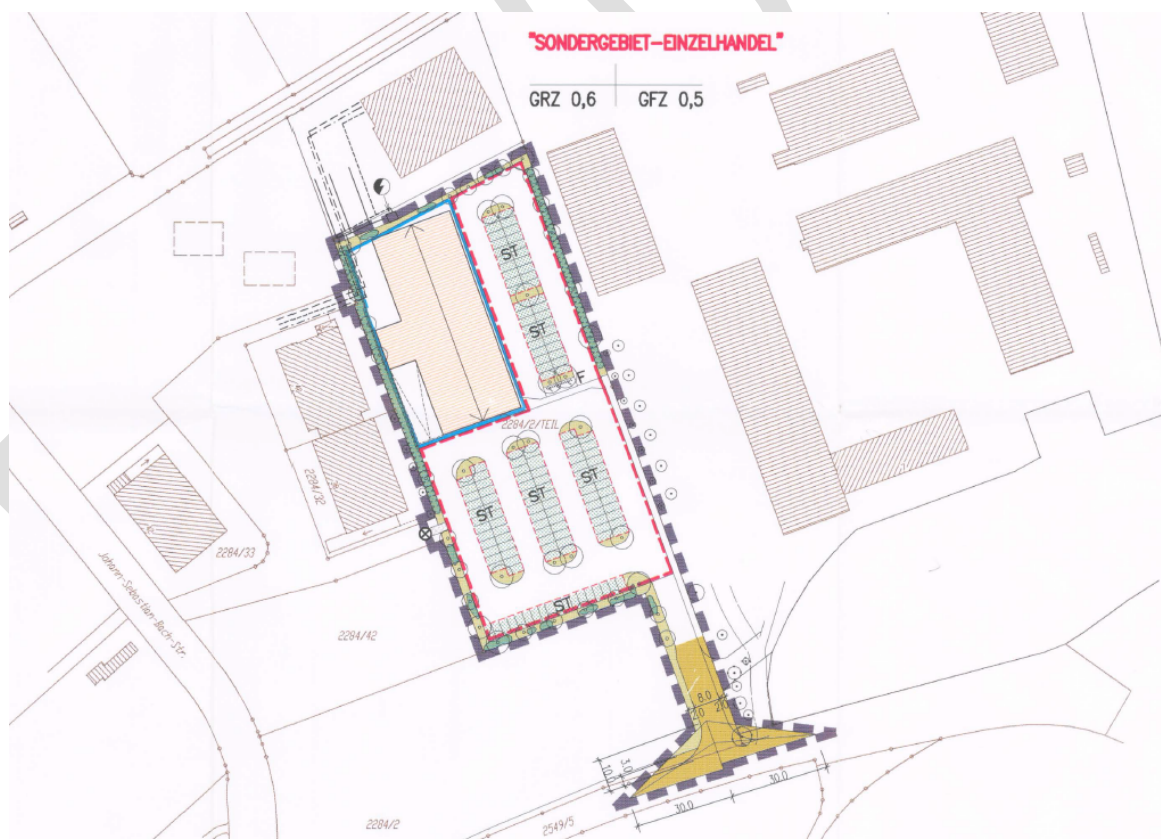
Bebauungsplan Nr. 151 „Vaterstetten, Sondergebiet – Einzelhandel, östlich des Gewerbegebietes“ - ohne Maßstab
